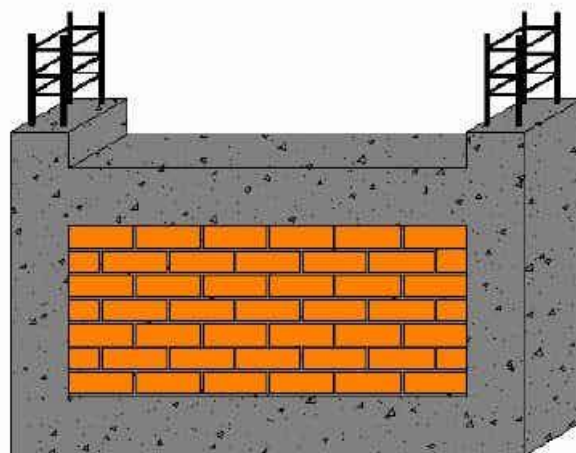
Mampostería de cavidad reforzada. Adaptado de *Concretos Presforzados de Servicio Nacional de Aprendizaje (2011)*.
